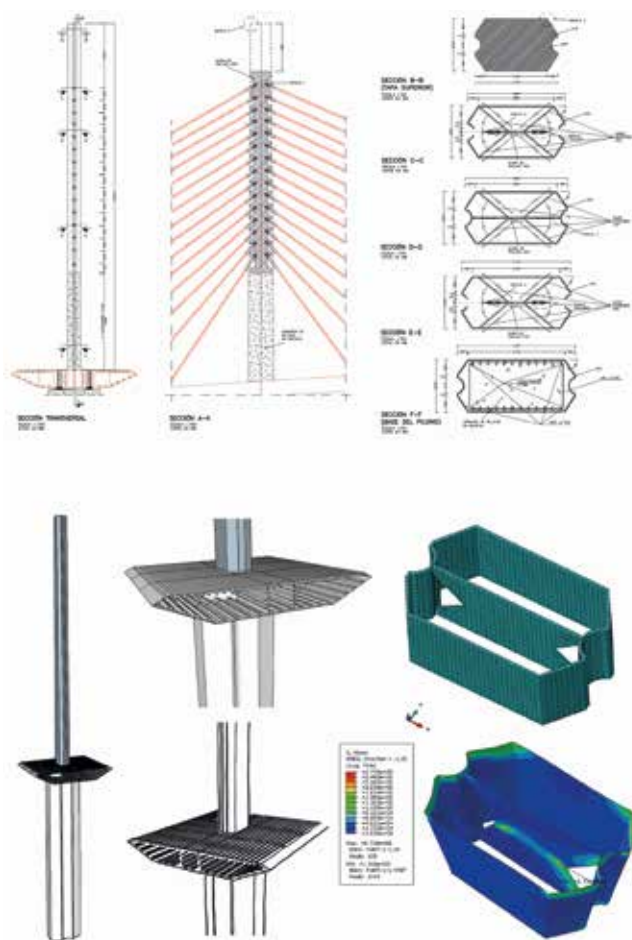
Detalles constructivos de los pilonos metálicos y de los modelos de elementos finitos utilizados para su validación estructural
